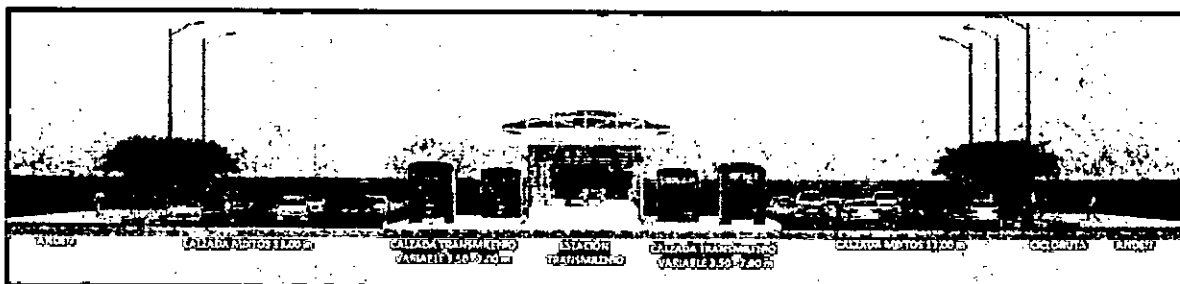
Sección transversal típica en estaciones tramo 2 desde Autopista Sur hasta la Diagonal 39 Sur.
